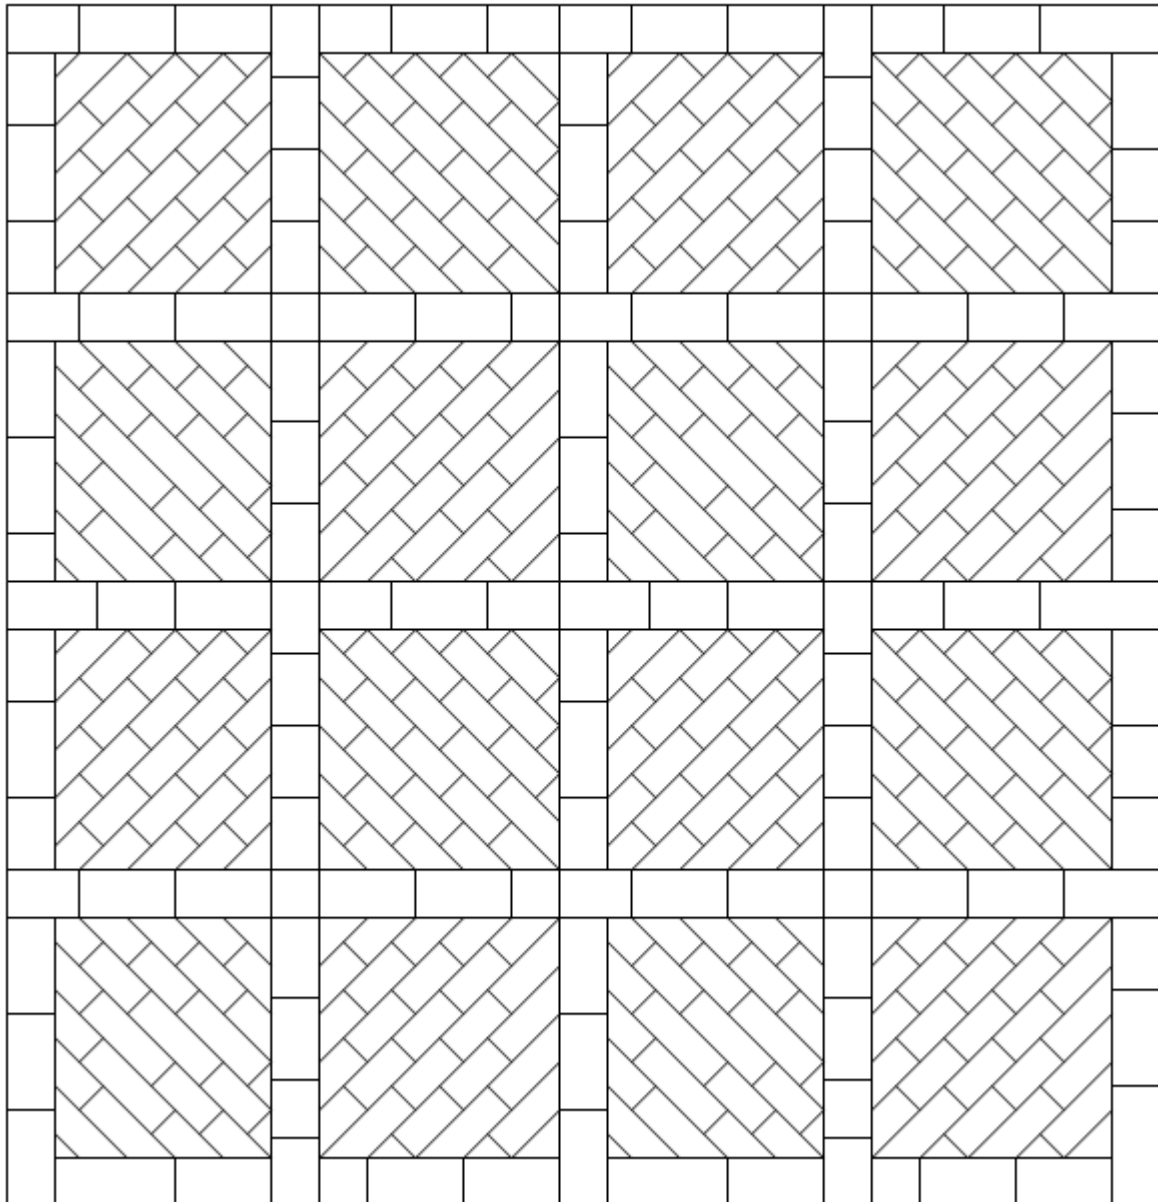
Schema reticolare del pavimento della zona centrale, dal primo gradino alla gradinata di ascesa al presbiterio.
